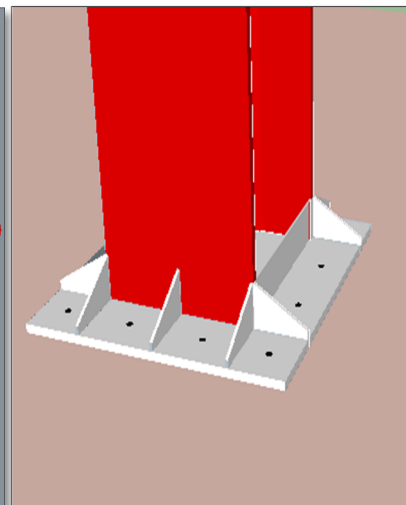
Fixation d'un poteau carré métallique sur une fondation
